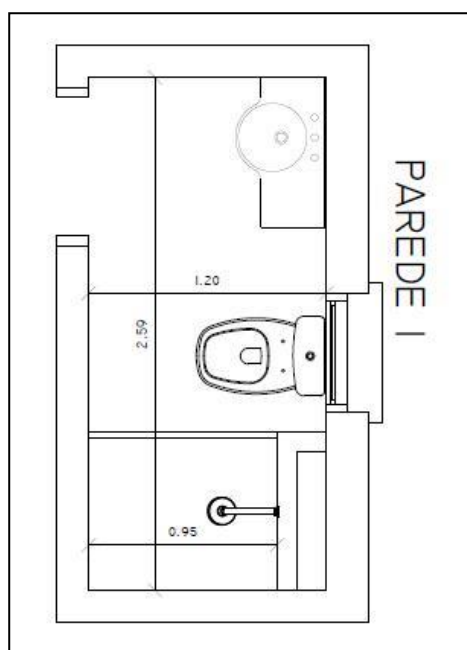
Planta baixa do banheiro da suíte, dos apartamentos de fundo.
